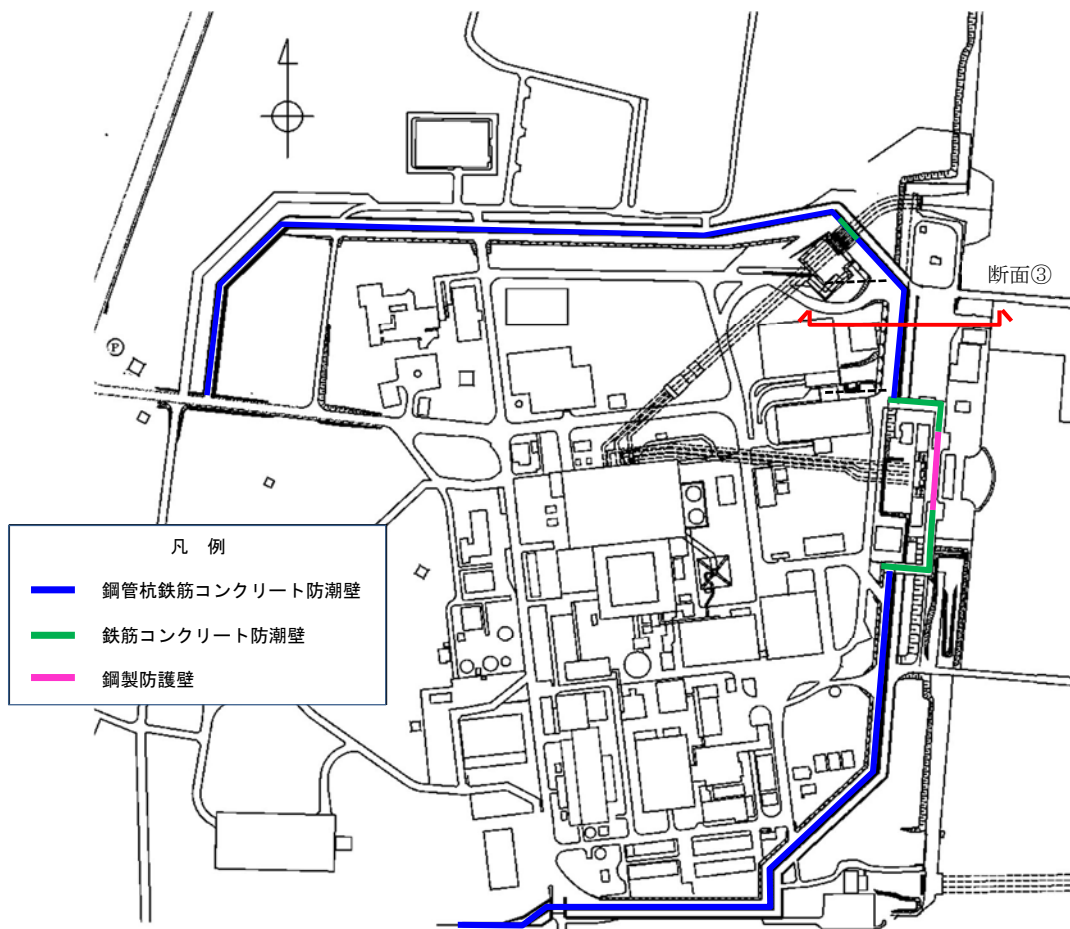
鋼管杭鉄筋コンクリート防潮壁の平面配置図（全体平面図）
